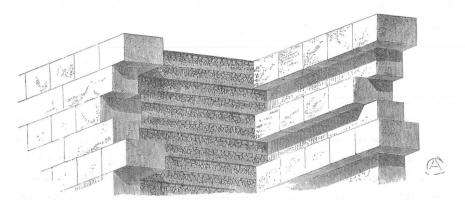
Aparejo de hiladas a soga alternadas con hiladas a tizón
